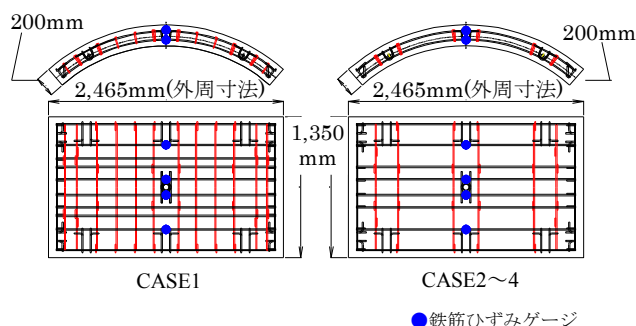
試験体の配筋図および鉄筋ひずみ計測位置
